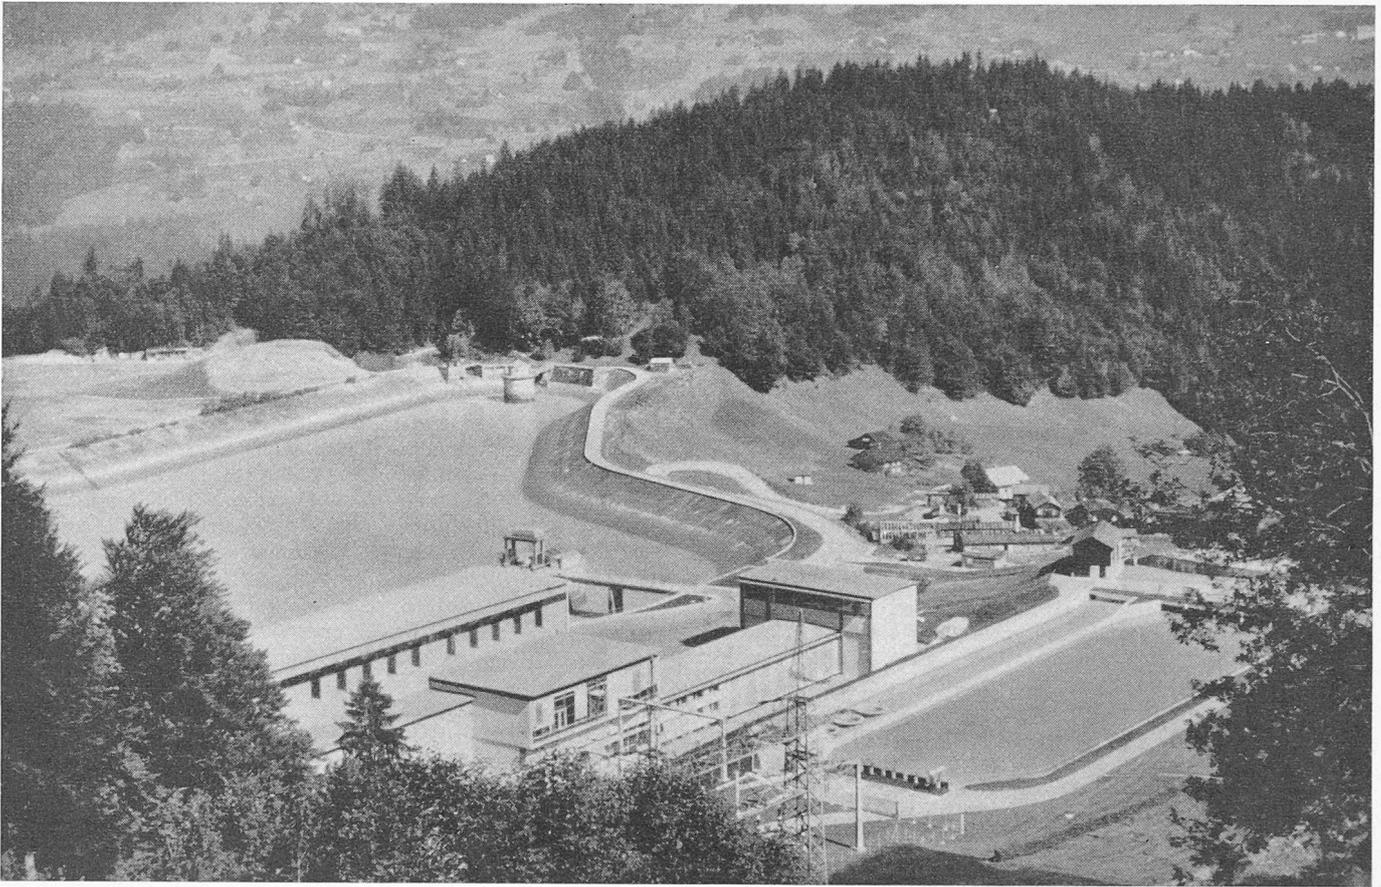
Das Maschinenhaus mit Pumpenwasserkanal und Staubecken Latschau (Photo Escher-Wyss)
